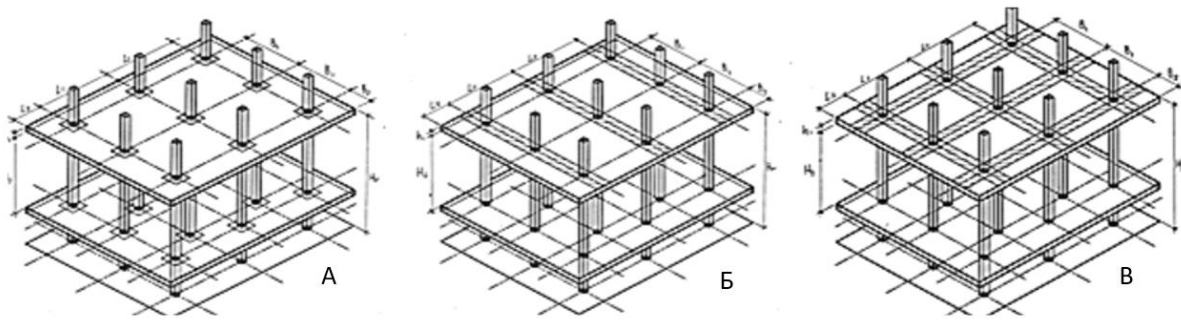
Схеми конструктивних рішень плоских монолітних плит перекриття: А – без балок з армуванням зон продавлювання; Б – з балками в одному напрямку; В – з балками в двох напрямках.
